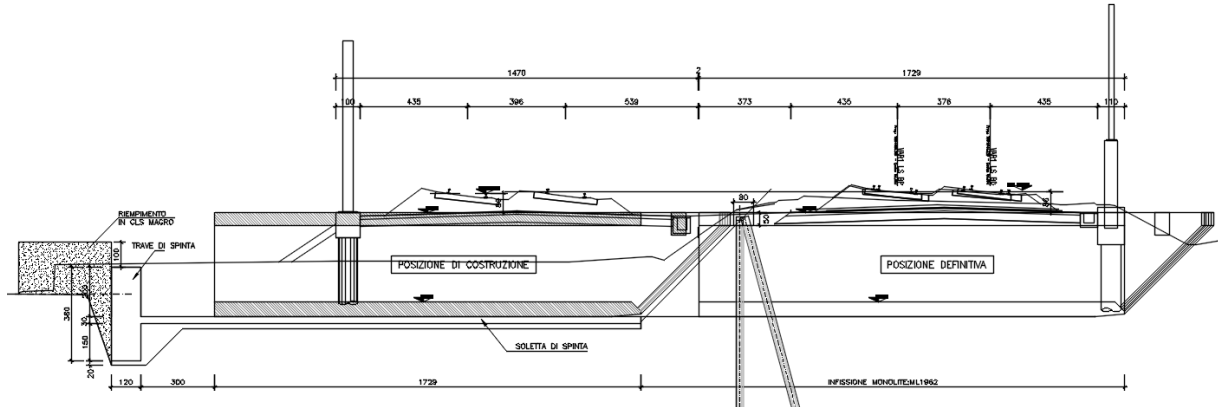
Sezione longitudinale Sottovia IN04 con monolite in posizione di varo
